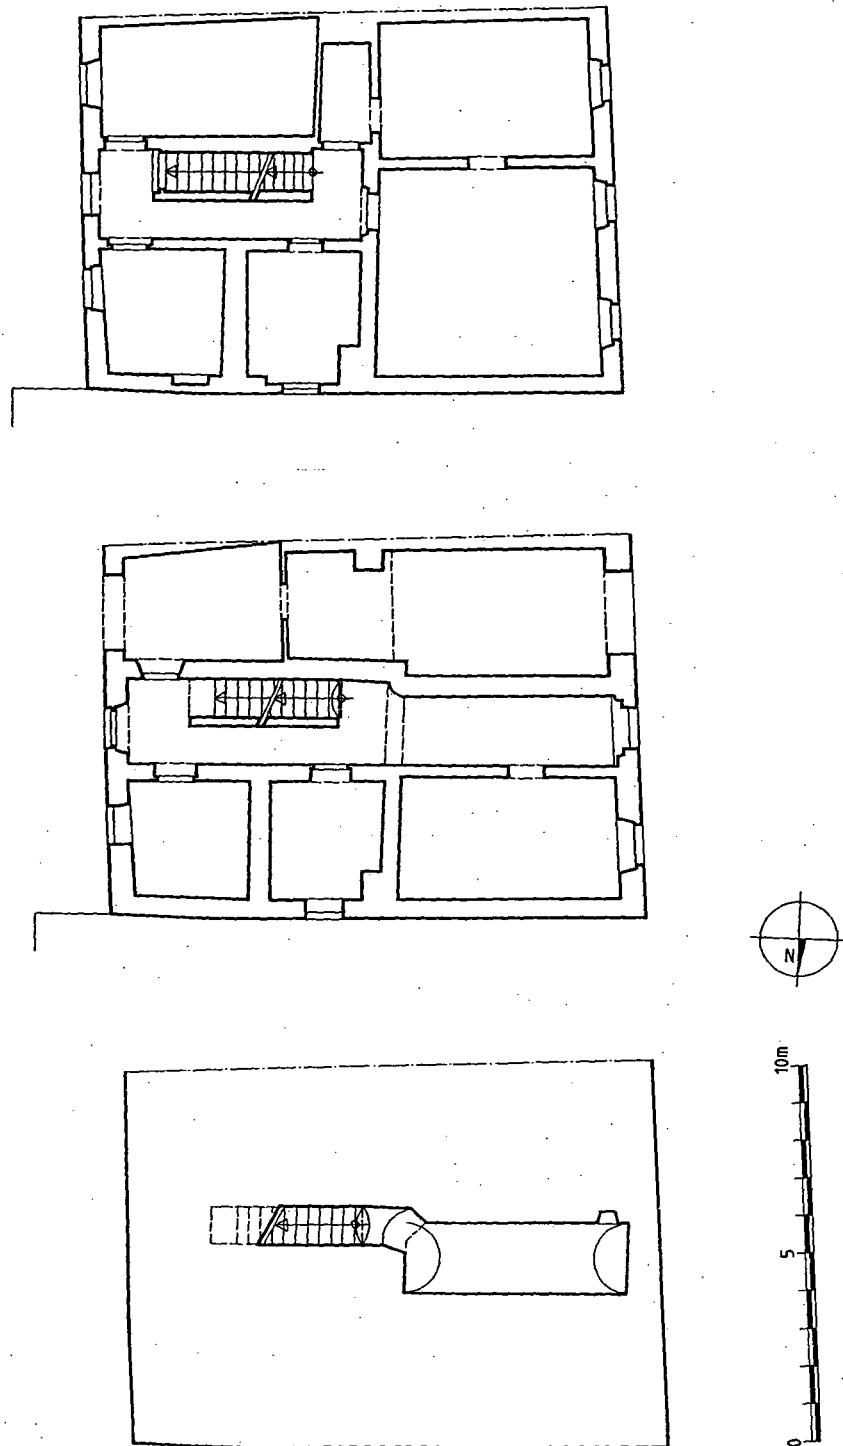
Stadtplatz 2 – Grundrisse Keller, Erdgeschoss, Obergeschoss (1:200).
